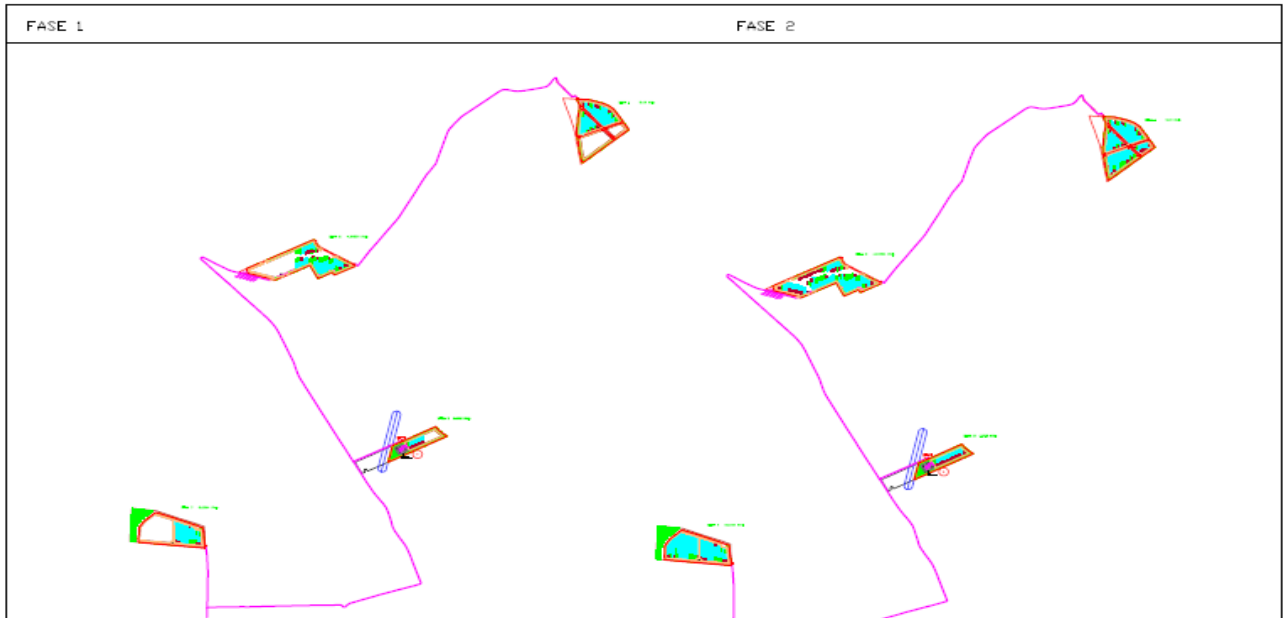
| Fasi di avanzamento lavori all'interno delle aree di impianto 1, 2, 3 e 7
